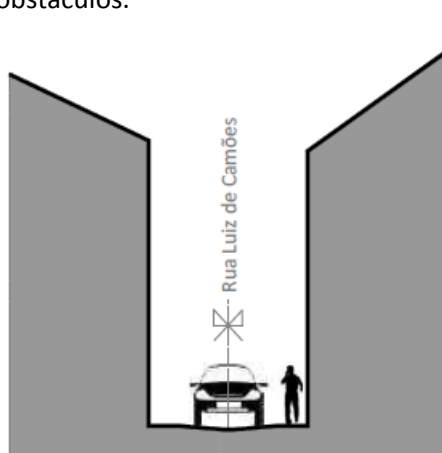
Perfil Transversal da proposta de requalificação da Rua Luiz de Camões.
